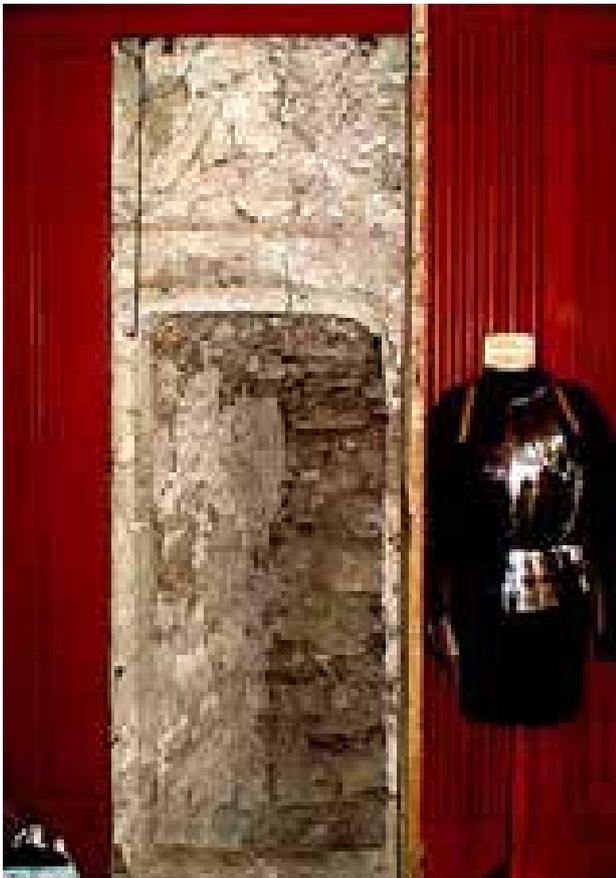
La porte située à l'angle nord-est du rez-de-chaussée du pavillon est, photographiée après ouverture du panneau pivotant du lambris (cl. J.Mesqui 2011)
